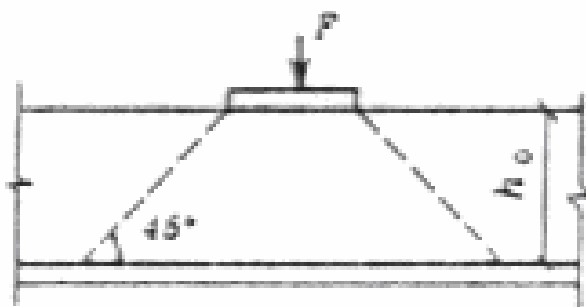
Схема для расчета железобетонных элементов на продавливание
